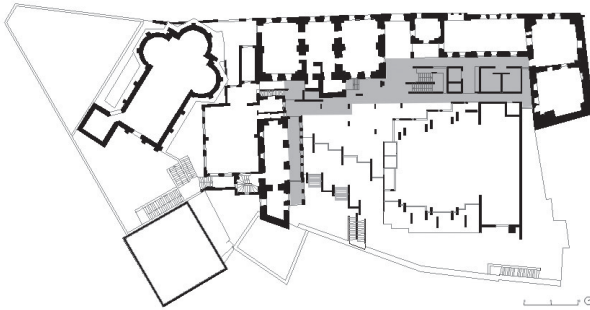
Plano del Centro cultural con la zona de transición, imagen de elaboración propia.
